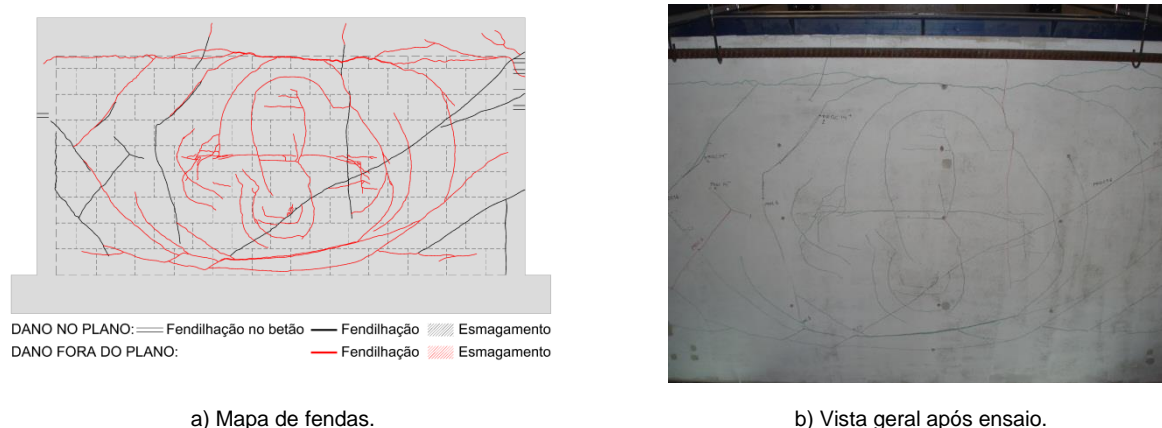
Padrão de fendilhação. Ensaio fora do plano, Wall_RAR_01.
